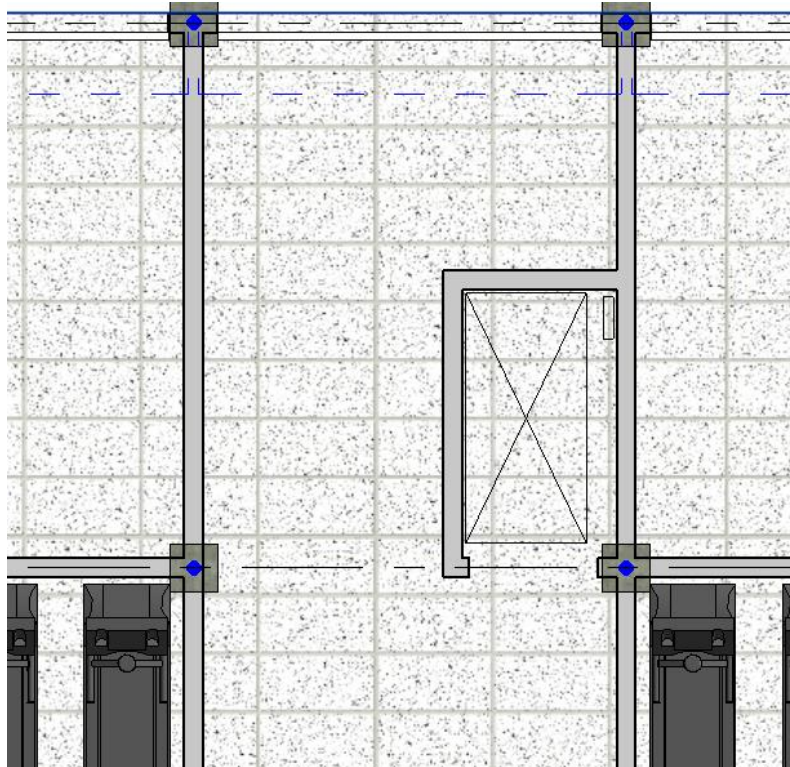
Vista en planta del ascensor. Fuente: elaboración propia.
